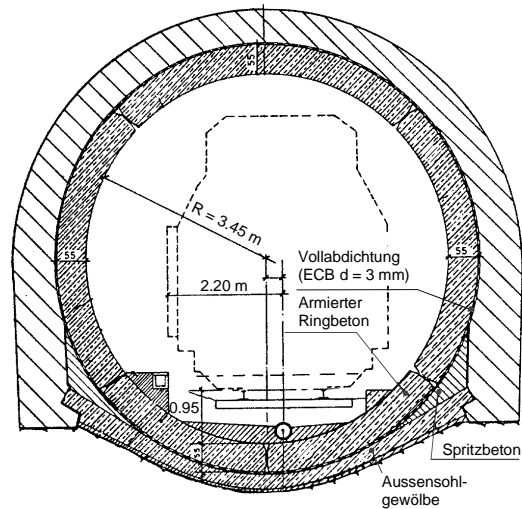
Kappelisbergtunnel: Sanierung durch den Einbau einer kreisförmigen Tunnelauskleidung aus Stahlbeton (Kurz, 1986)
